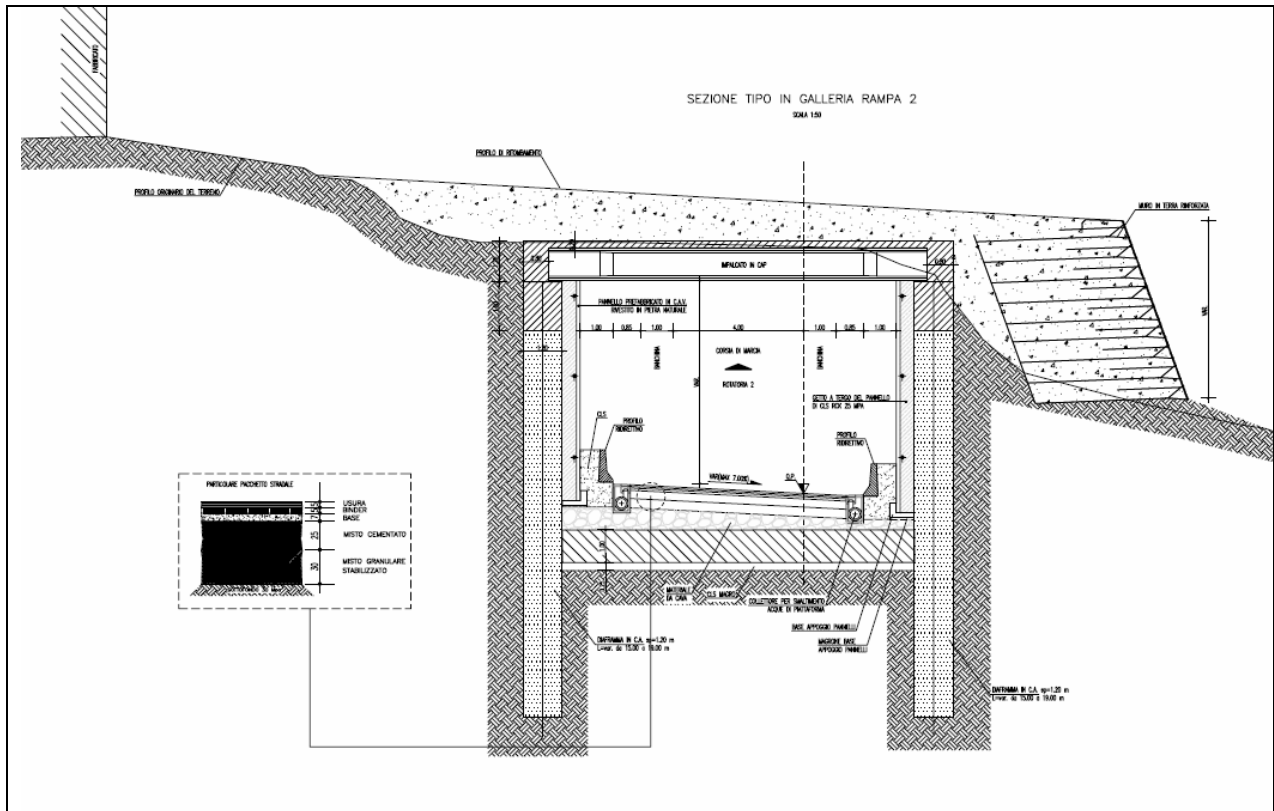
Sezione trasversale tipo galleria artificiale RAMPA2
